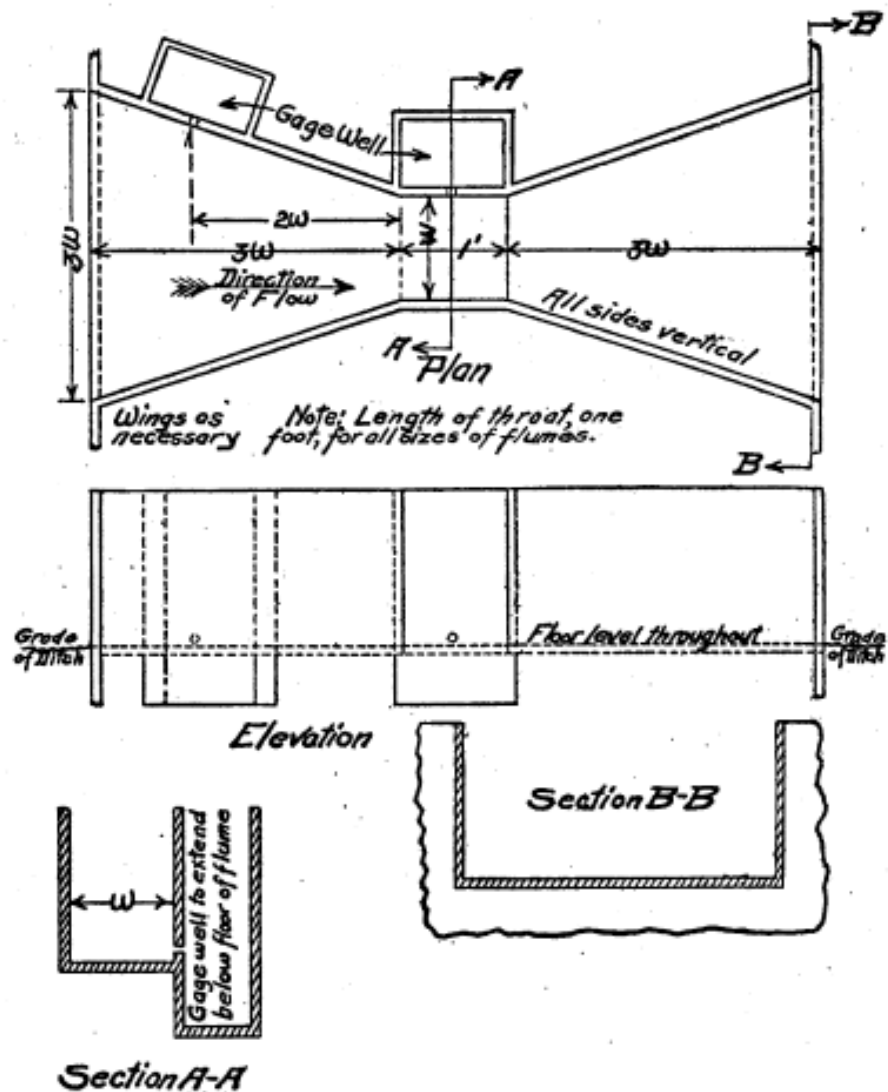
11: Aforador Venturi en planta y perfil, con sección rectangular.
